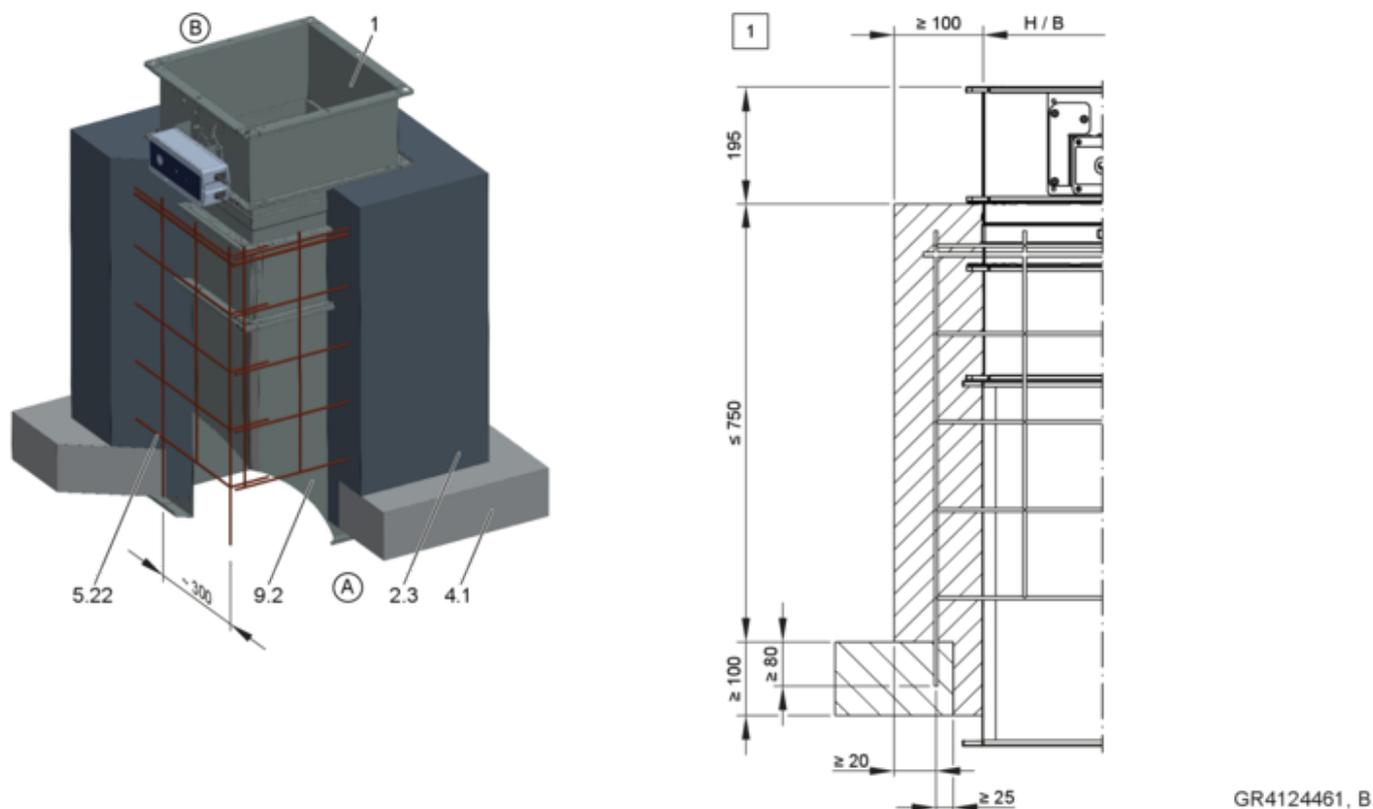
Montagem em argamassa com base de betão para uma placa de teto maciça, em pé
